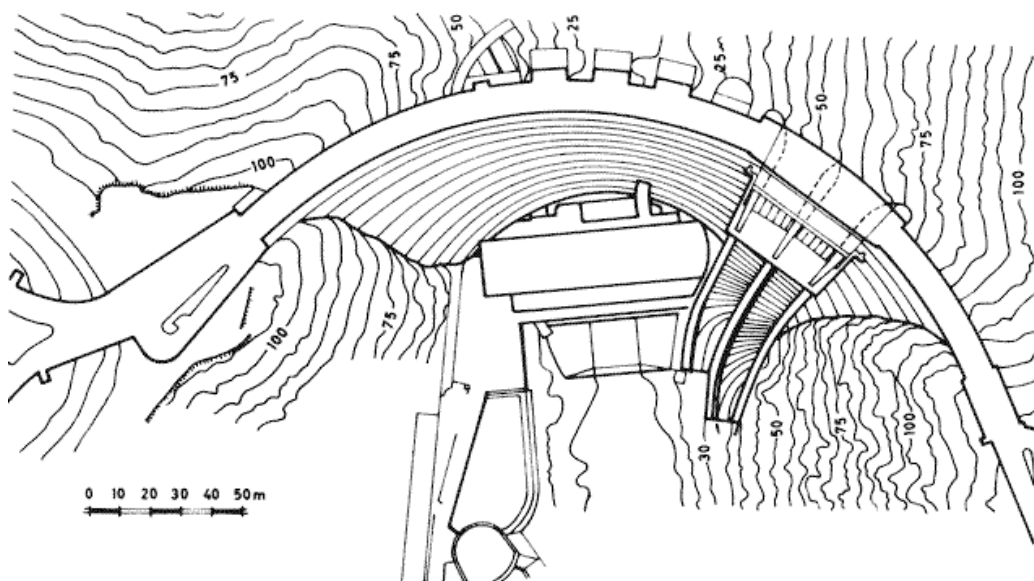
Barragem de Castelo do Bode. Planta (fonte: www.inag.pt)
